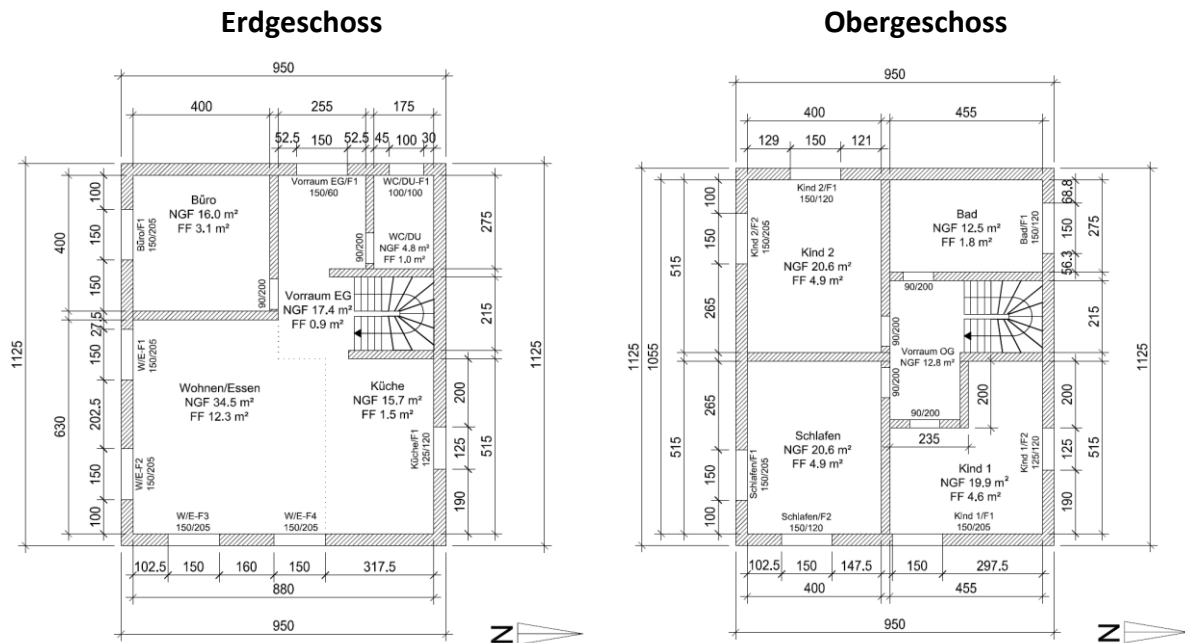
Grundrisse des Referenzgebäudes mit mittleren Glasflächen. Die Nettogrundfläche ist mit NGF, die Fensterfläche ist mit FF bezeichnet.
